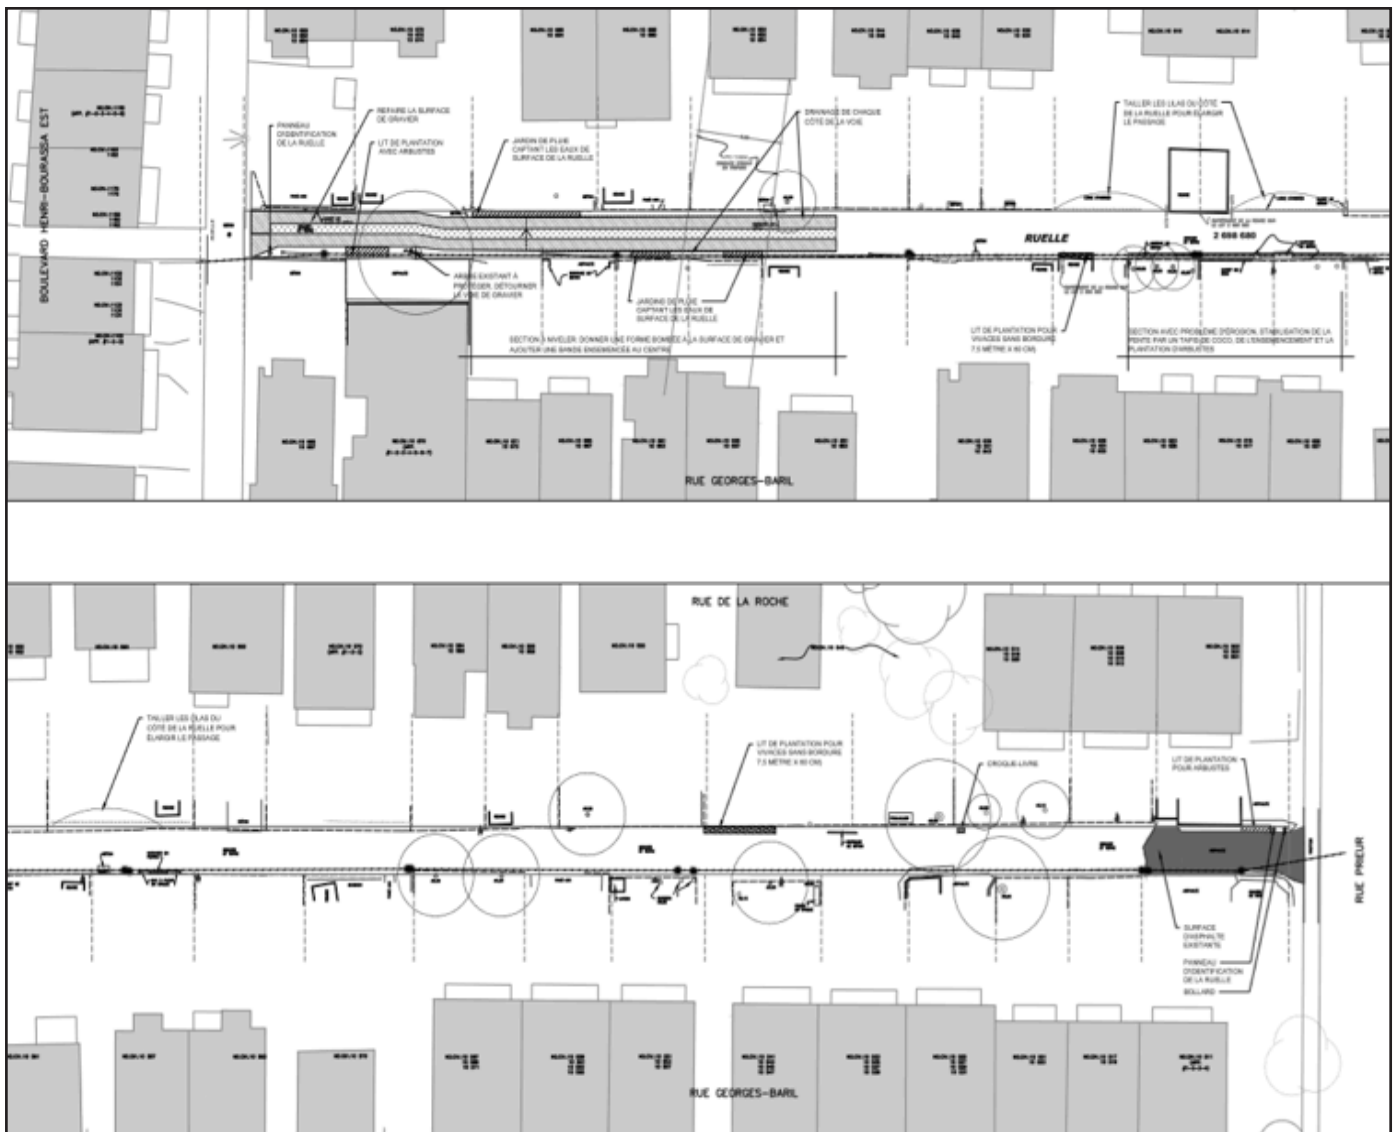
Plan d'aménagement Crédits : Ville en vert
